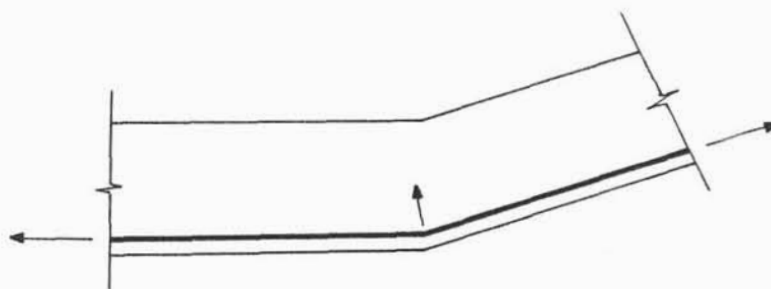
Detalhe dos esforços em um canto saliente tracionado.
